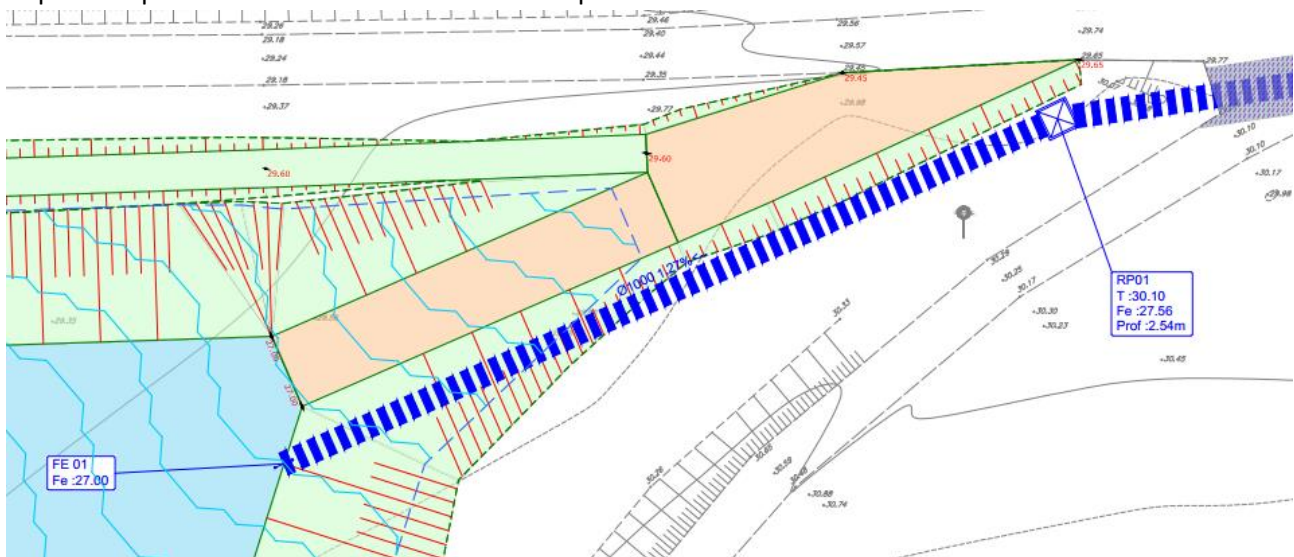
Rampe terre/pierre d'accès à l'ouvrage PD-B5
